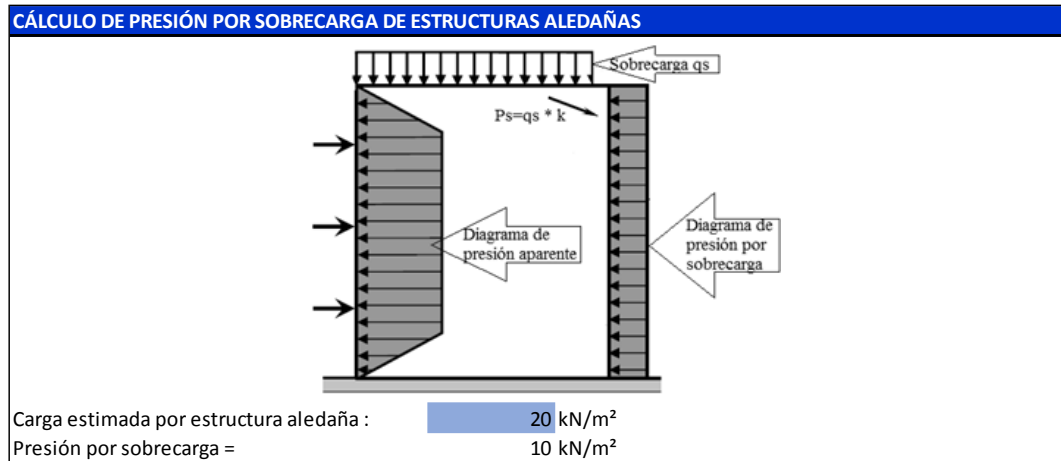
Cálculo de presión por sobrecarga de estructuras aledañas
